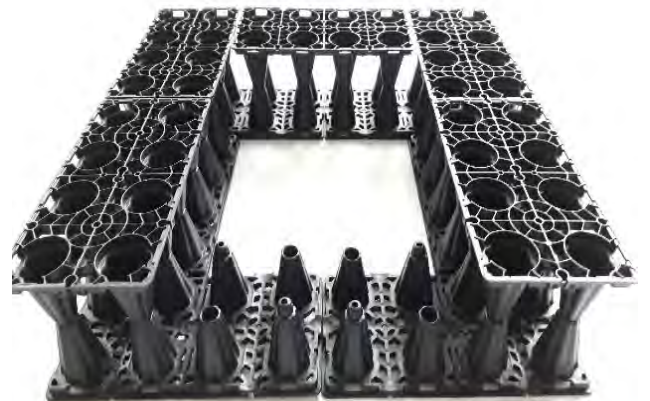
Пошаговый процесс формирования шахты доступа в резервуар
